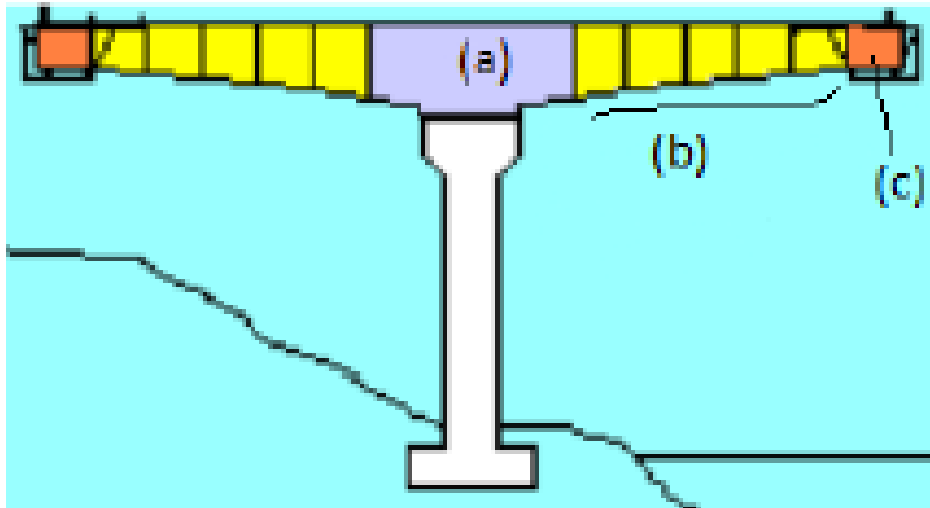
Vista de la sección longitudinal de un puente por etapas: (a) dovela inicial o 0, (b) dovelas finalizadas, (c) dovela en construcción.
